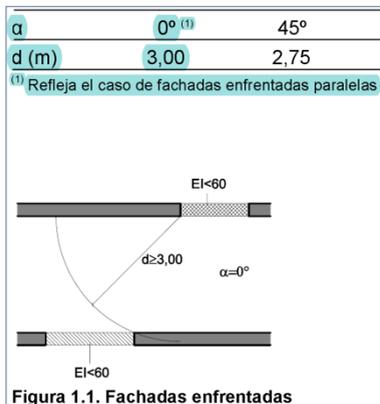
Figura 1.1 Fachadas enfrentadas. Fuente: CTE DB SI-2 apartado 1 Medianeras y fachadas.
